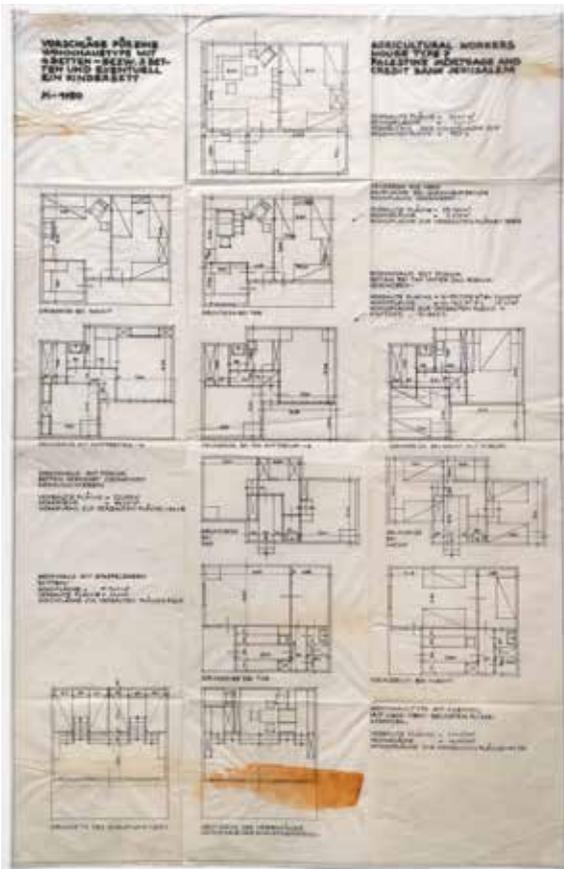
Grundrissvarianten der „Agricultural Workers House Type 7“, Entwurfszeichnung, um 1934–1936, AGS.
